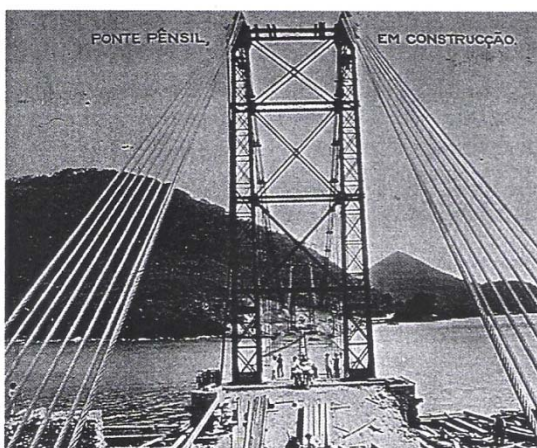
Foto da ponte em sua construção, do livro Pontes do Brasil (1993)
